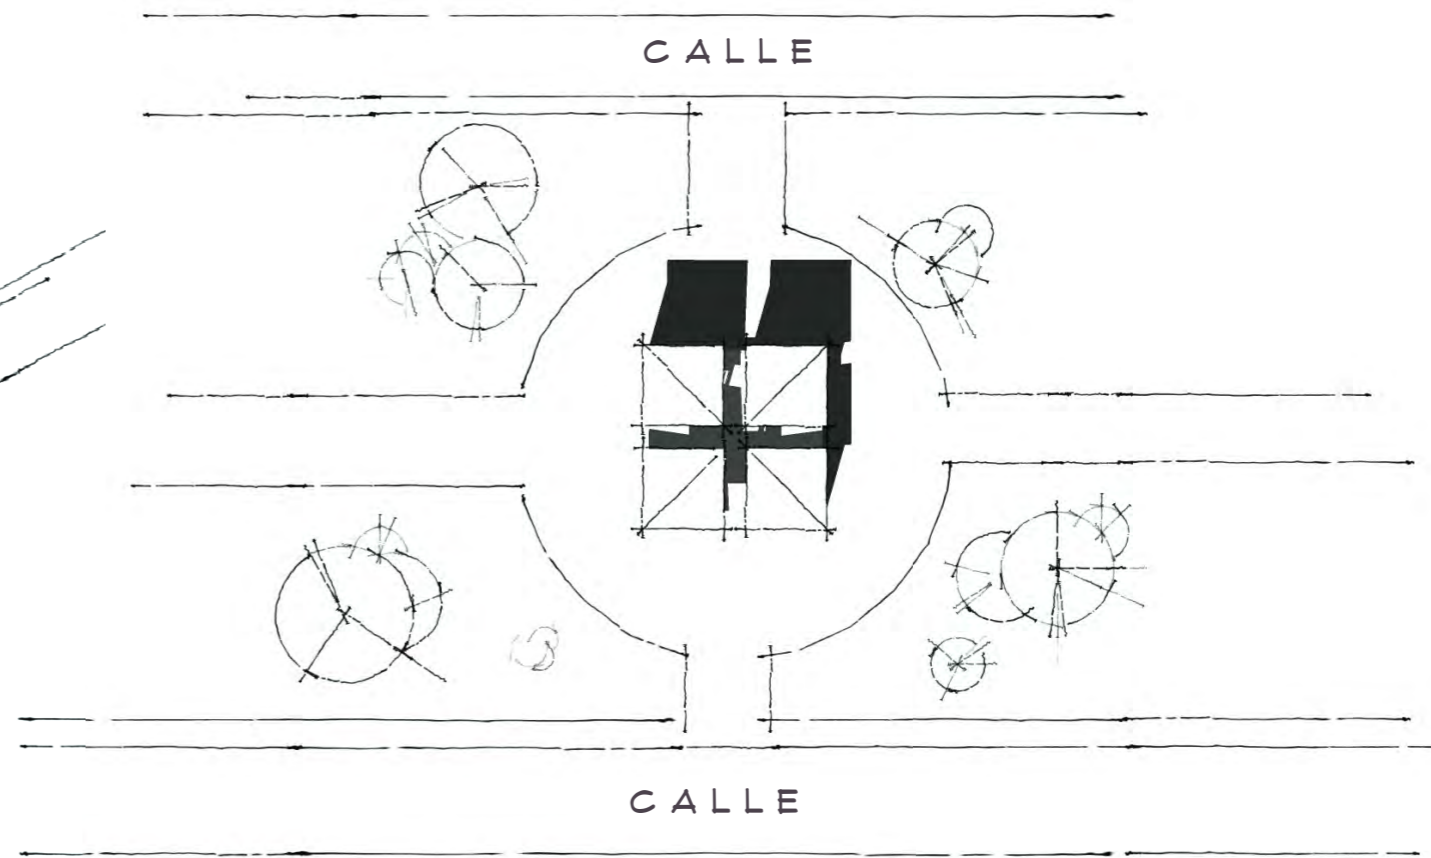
Croquis de emplazamiento de proyecto, ubicado en zonas públicas, elaborado por César Hernández, 2018.
